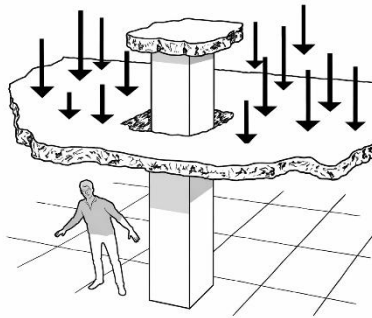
Poinçonnement d'un poteau dans une dalle [3]
